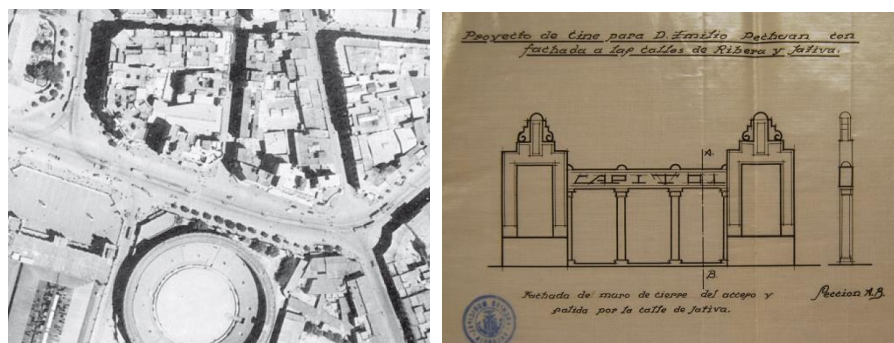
01 Foto aérea de Valencia 1944. 02 Alzado de la fachada a la calle Játiva del Cine Capitol
